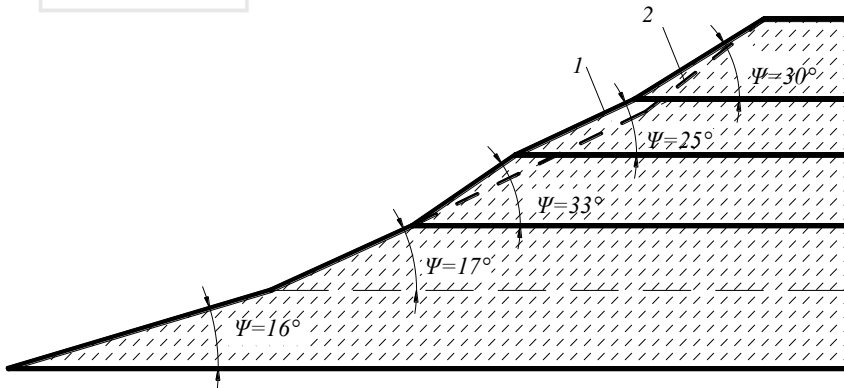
Схема розрахунку стійкого укосу в шаруватому ґрунті: 1 – поверхня ґрунту; 2 – поверхня стійкого укосу
